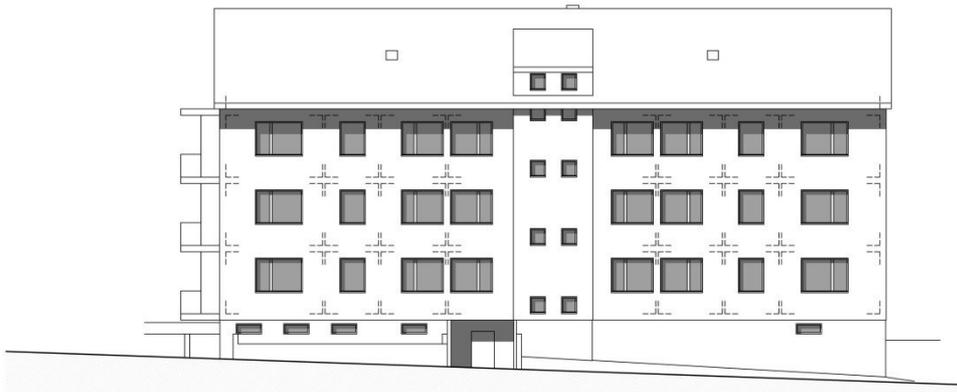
Fallbeispiel, Plan Südost-Fassade
